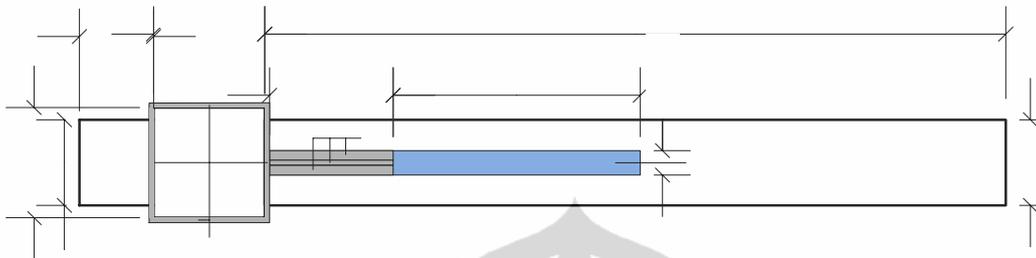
Tampak Atas Pemasangan CFRP & L-30X20X5 pada Balok
